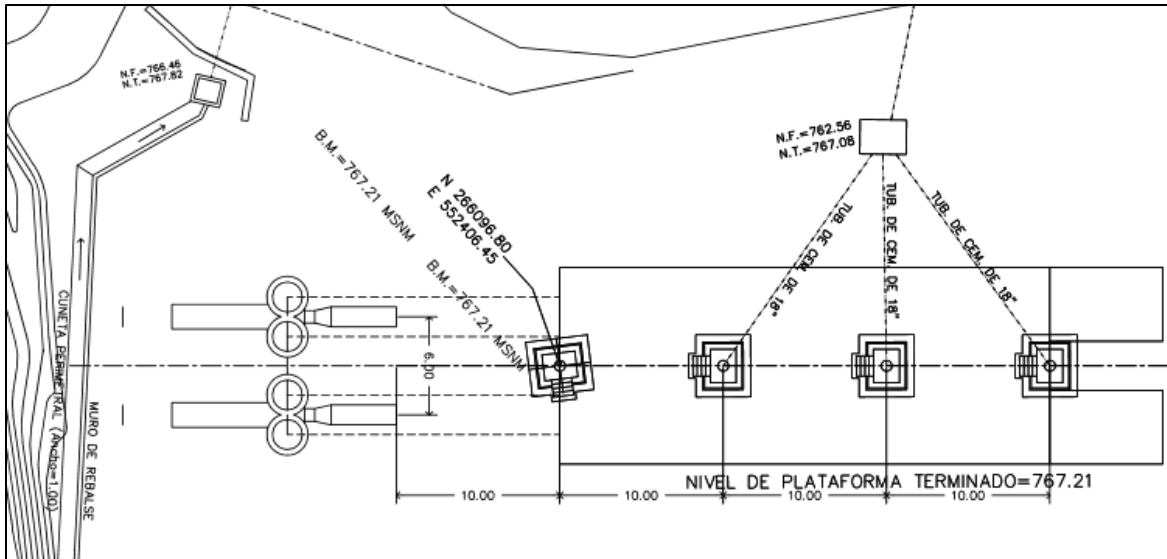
Vista de planta de silenciadores y contrapozo, plataforma DG-01
